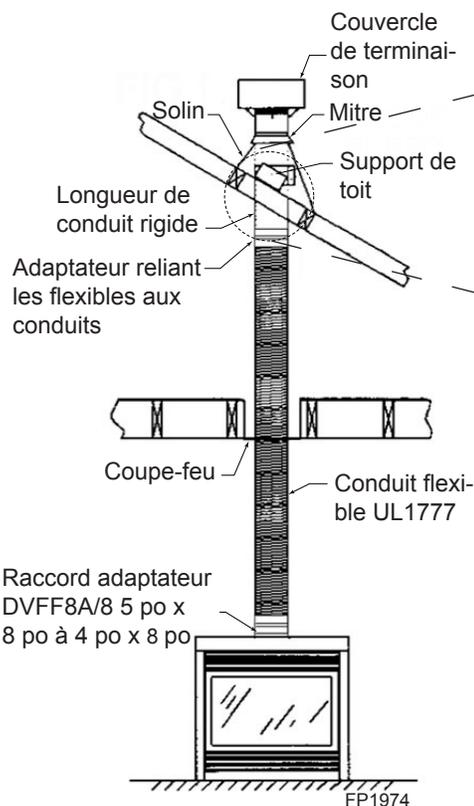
Installation typique d'un conduit de ventilation flexible vertical
